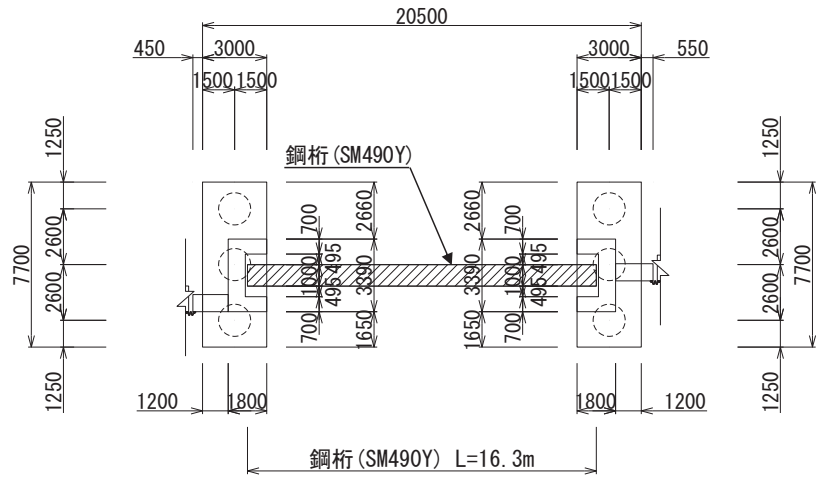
8(2) 鋼製遮水壁 (鋼桁 5) 平面図
